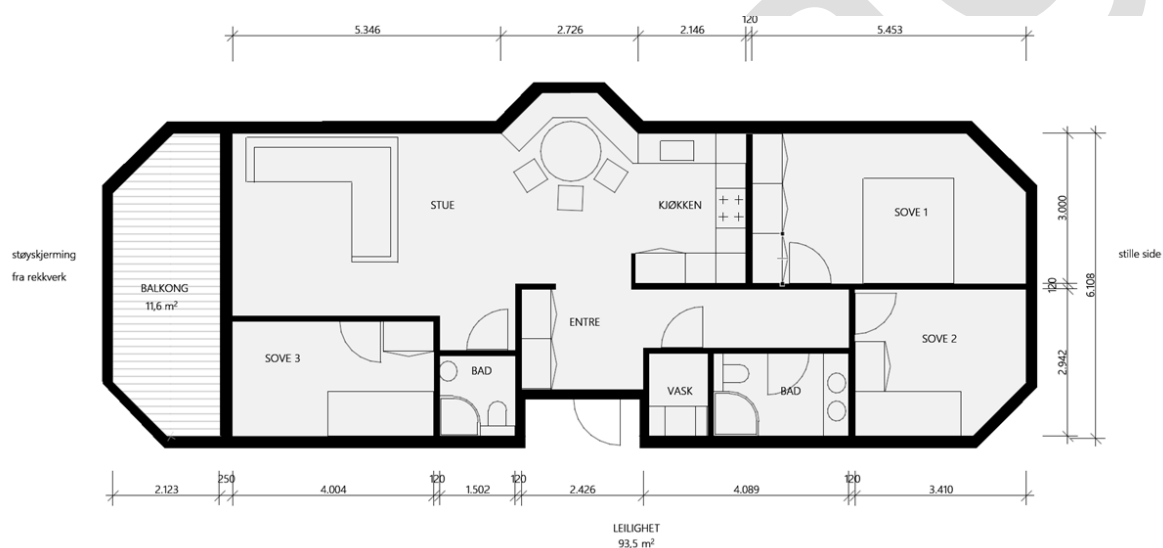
Fasaden mot vest (t.h.) er trukket inn. Dette gir et privat uterom, hvor tett rekkverk sørger for dempet fasade bakom, Lden=57 dB.
